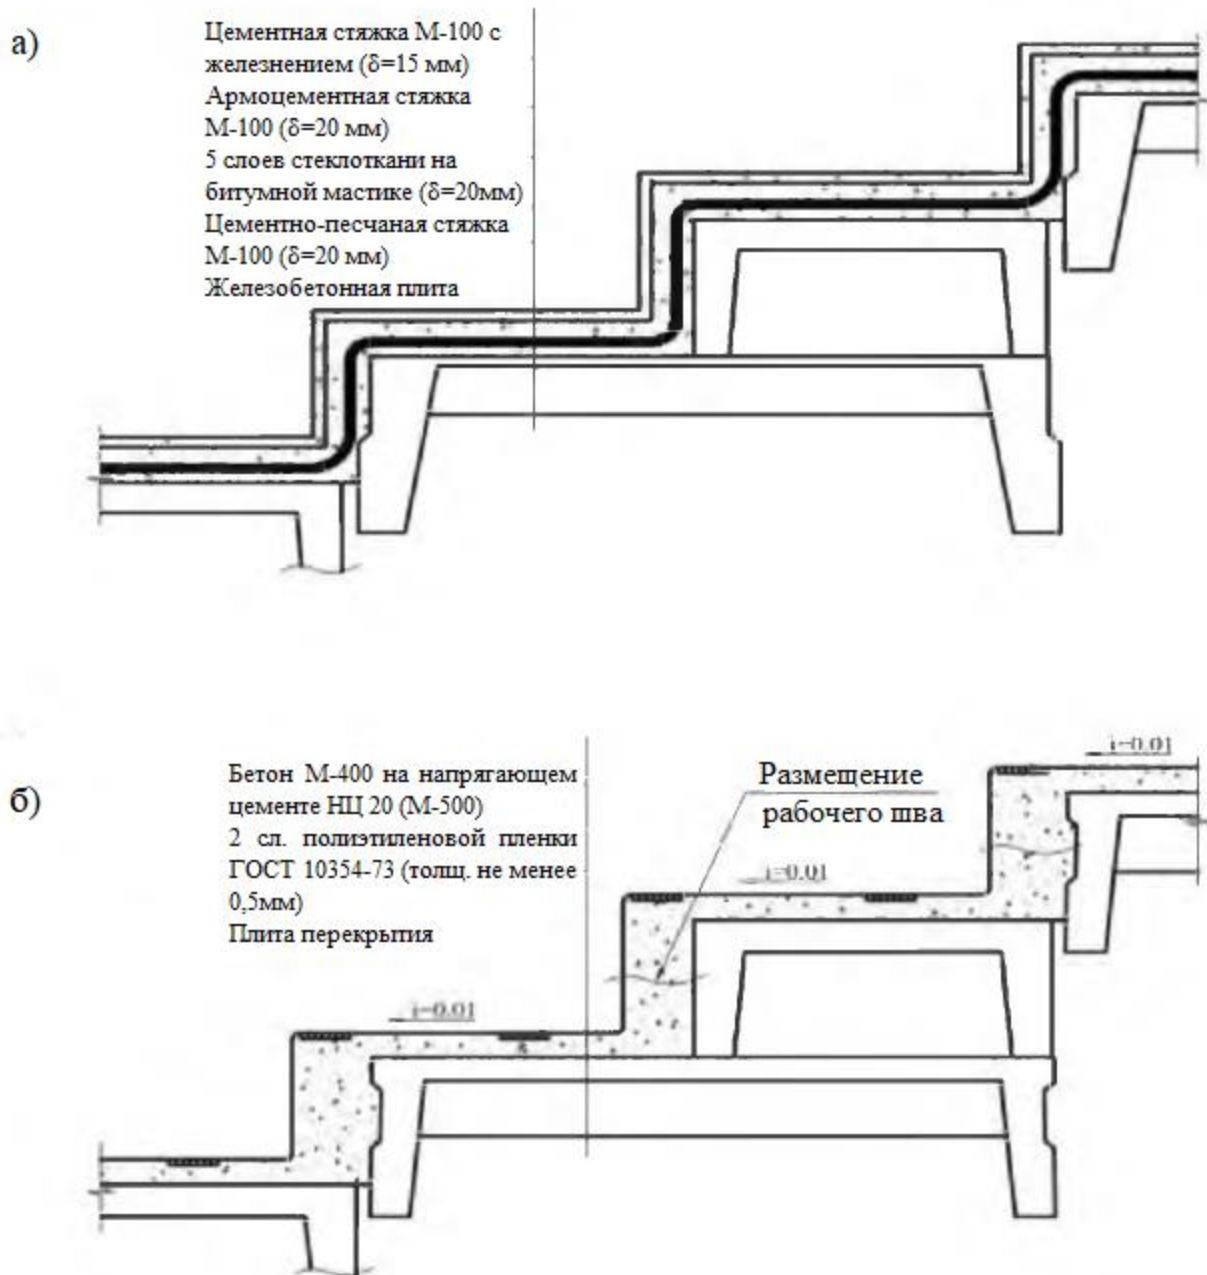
Конструктивное решение ступенчатого покрытия (например трибун стадиона) с рулонной гидроизоляцией (а) и из монолитного атмосферостойкого бетона (б)
